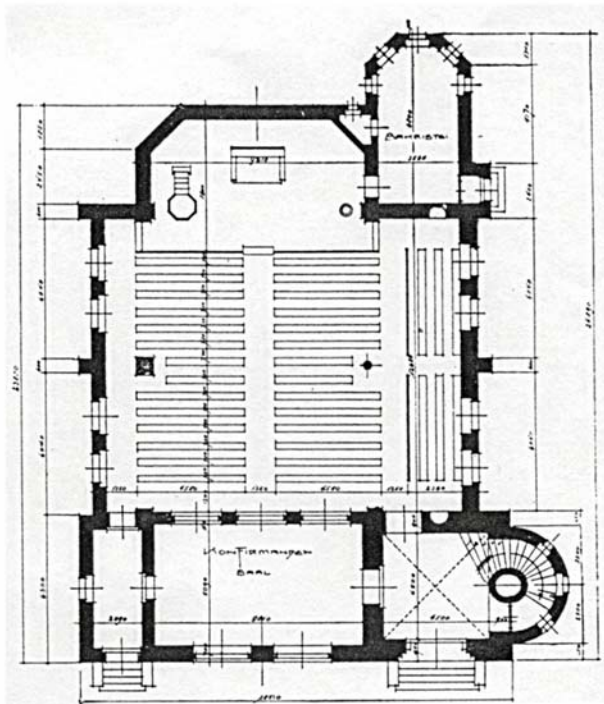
Grundriss Kirchengebäude Erdgeschoss
